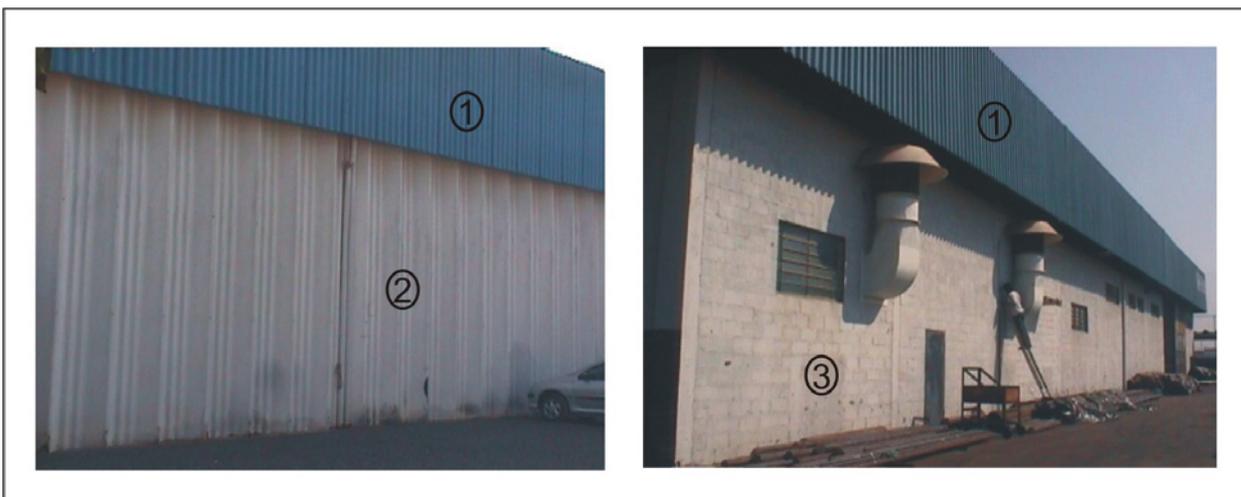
Placas de fibro cimento (calhetão) e alvenaria de concreto
